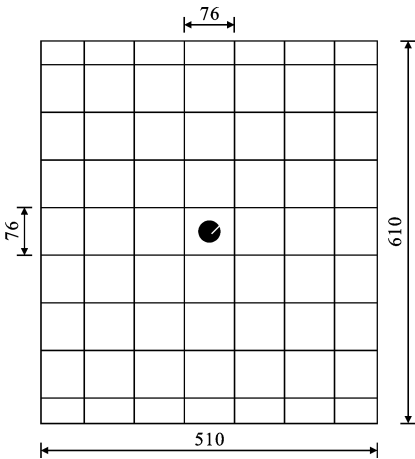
钢筋平面布置及弹体冲击位置(单位:mm)
